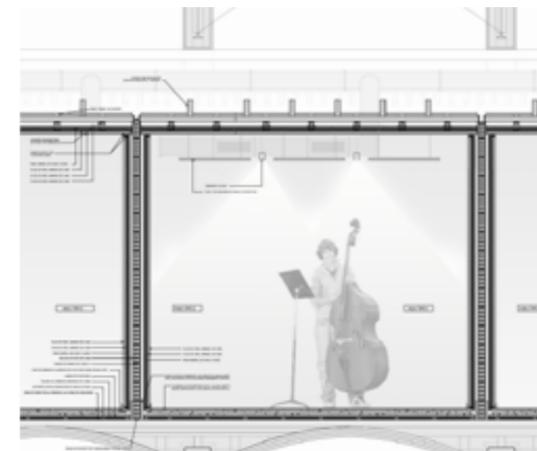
Detalle constructivo del acondicionamiento acústico.
